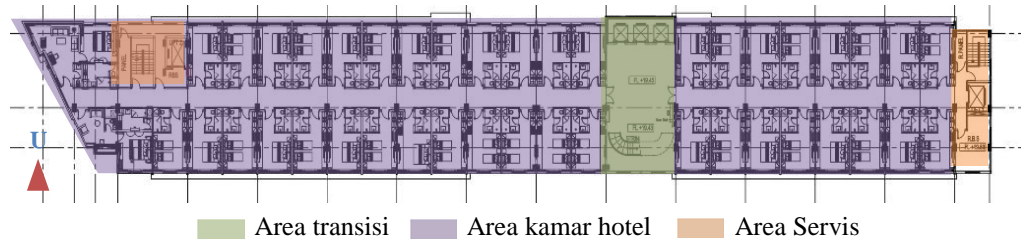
Denah Lantai Tipikal 5,6,7
